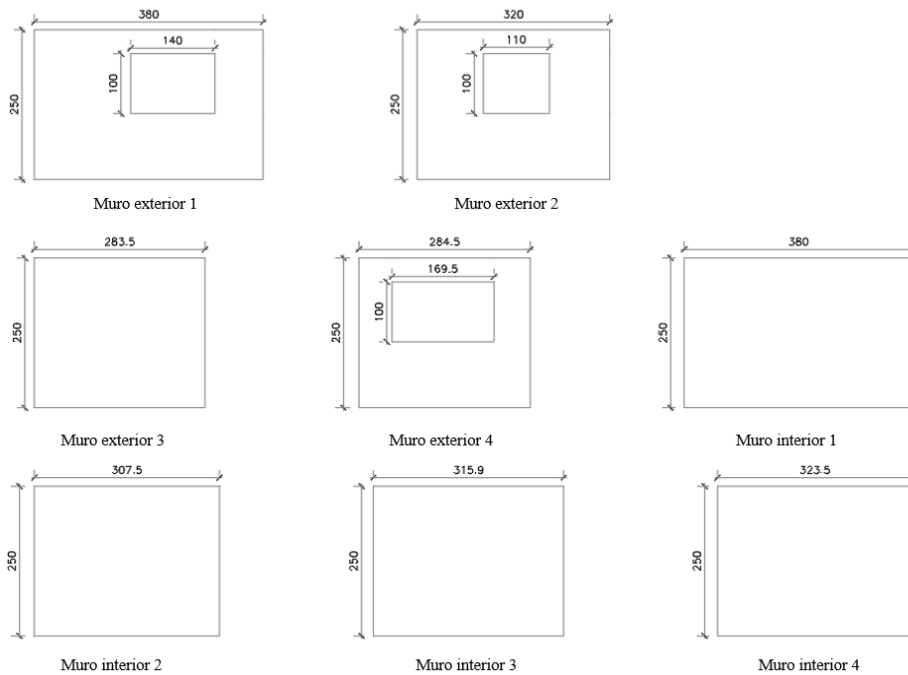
Muros que componen la estructura con sus dimensiones en centímetros.
